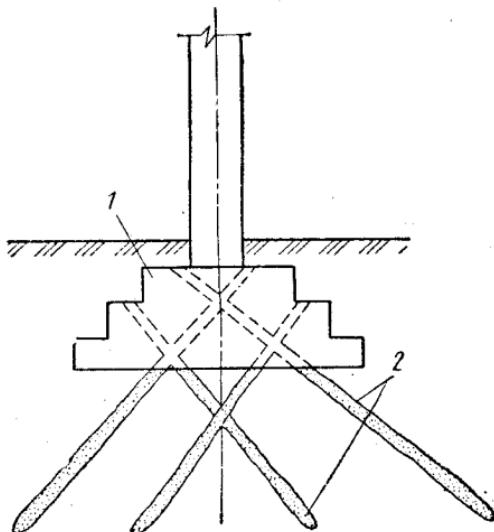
Усиление фундамента с помощью корневидных свай:
